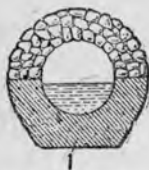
Дренаж из бетона и сухой каменной кладки.
